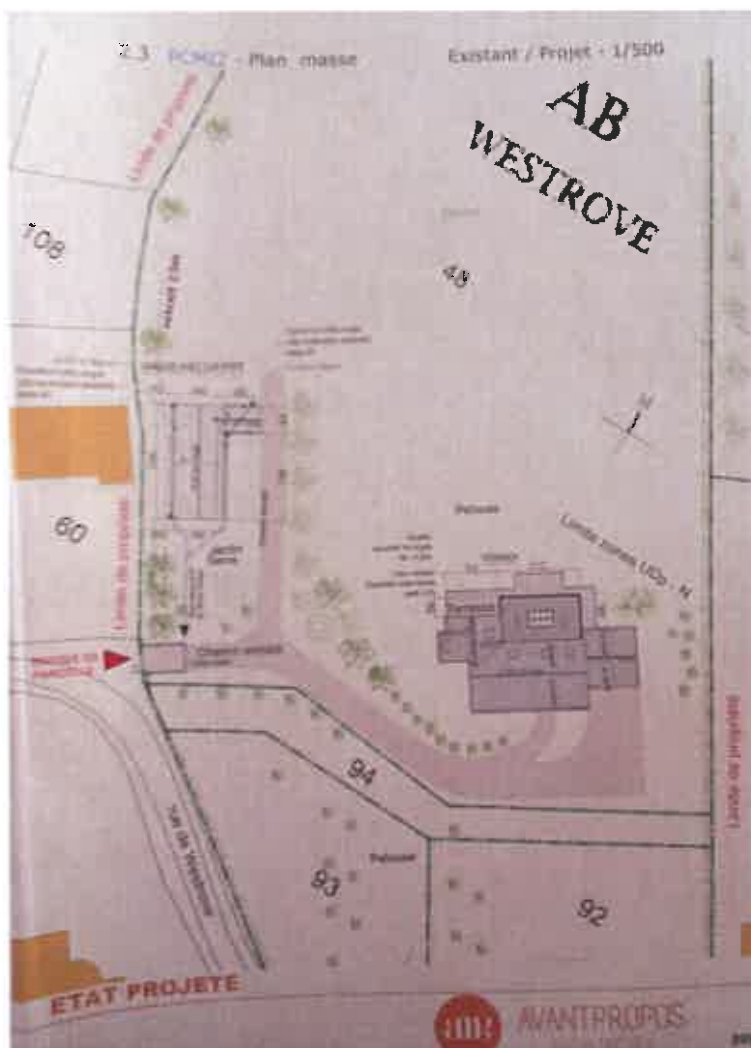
PHOTO DE DROITE : Implantation du Projet de construction dans le nouveau zonage, par le Commissaire Enquêteur. sur le fond de plan coté fourni par la CAPSO en tenant compte de la déformation d'échelle.
